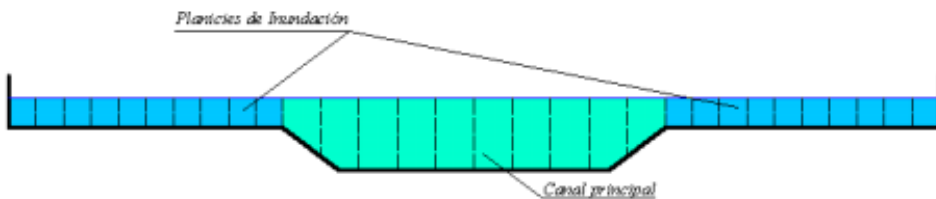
Subdivisión de la sección transversal en HEC – RAS – cada zona se divide en n partes
